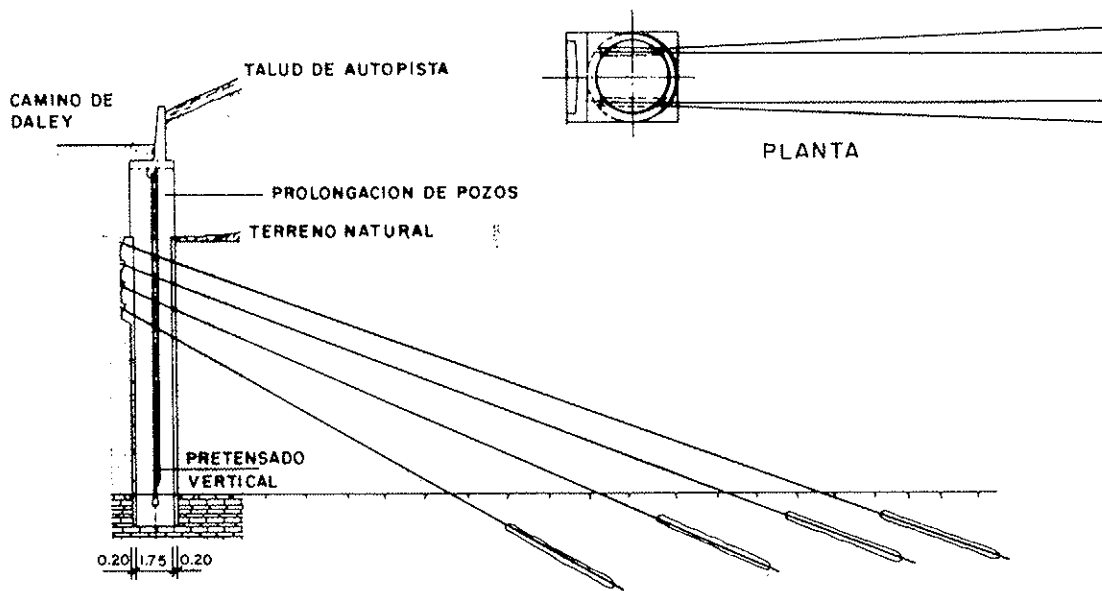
Muro sobre pantalla de pozos anclados (autopista de Léman, Karakas, 1973).
